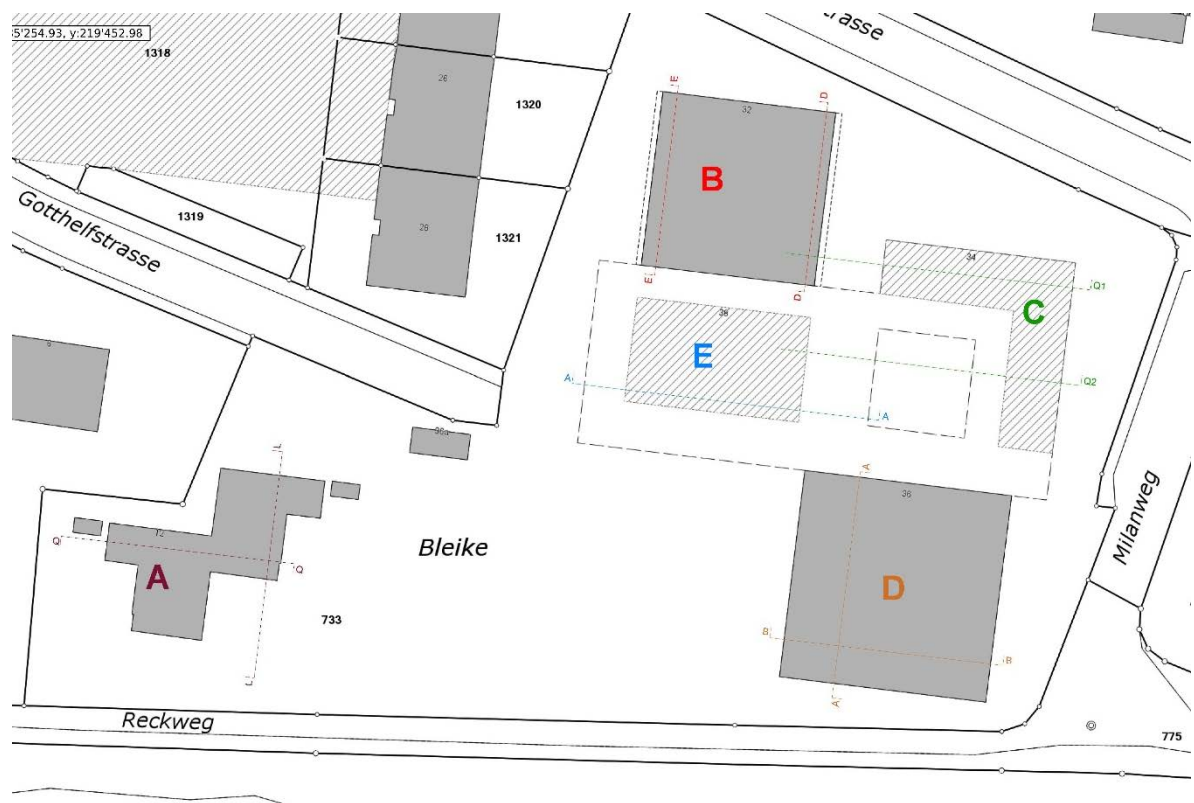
Situationsplan Schulanlage Weidteile (ohne Massstab)
